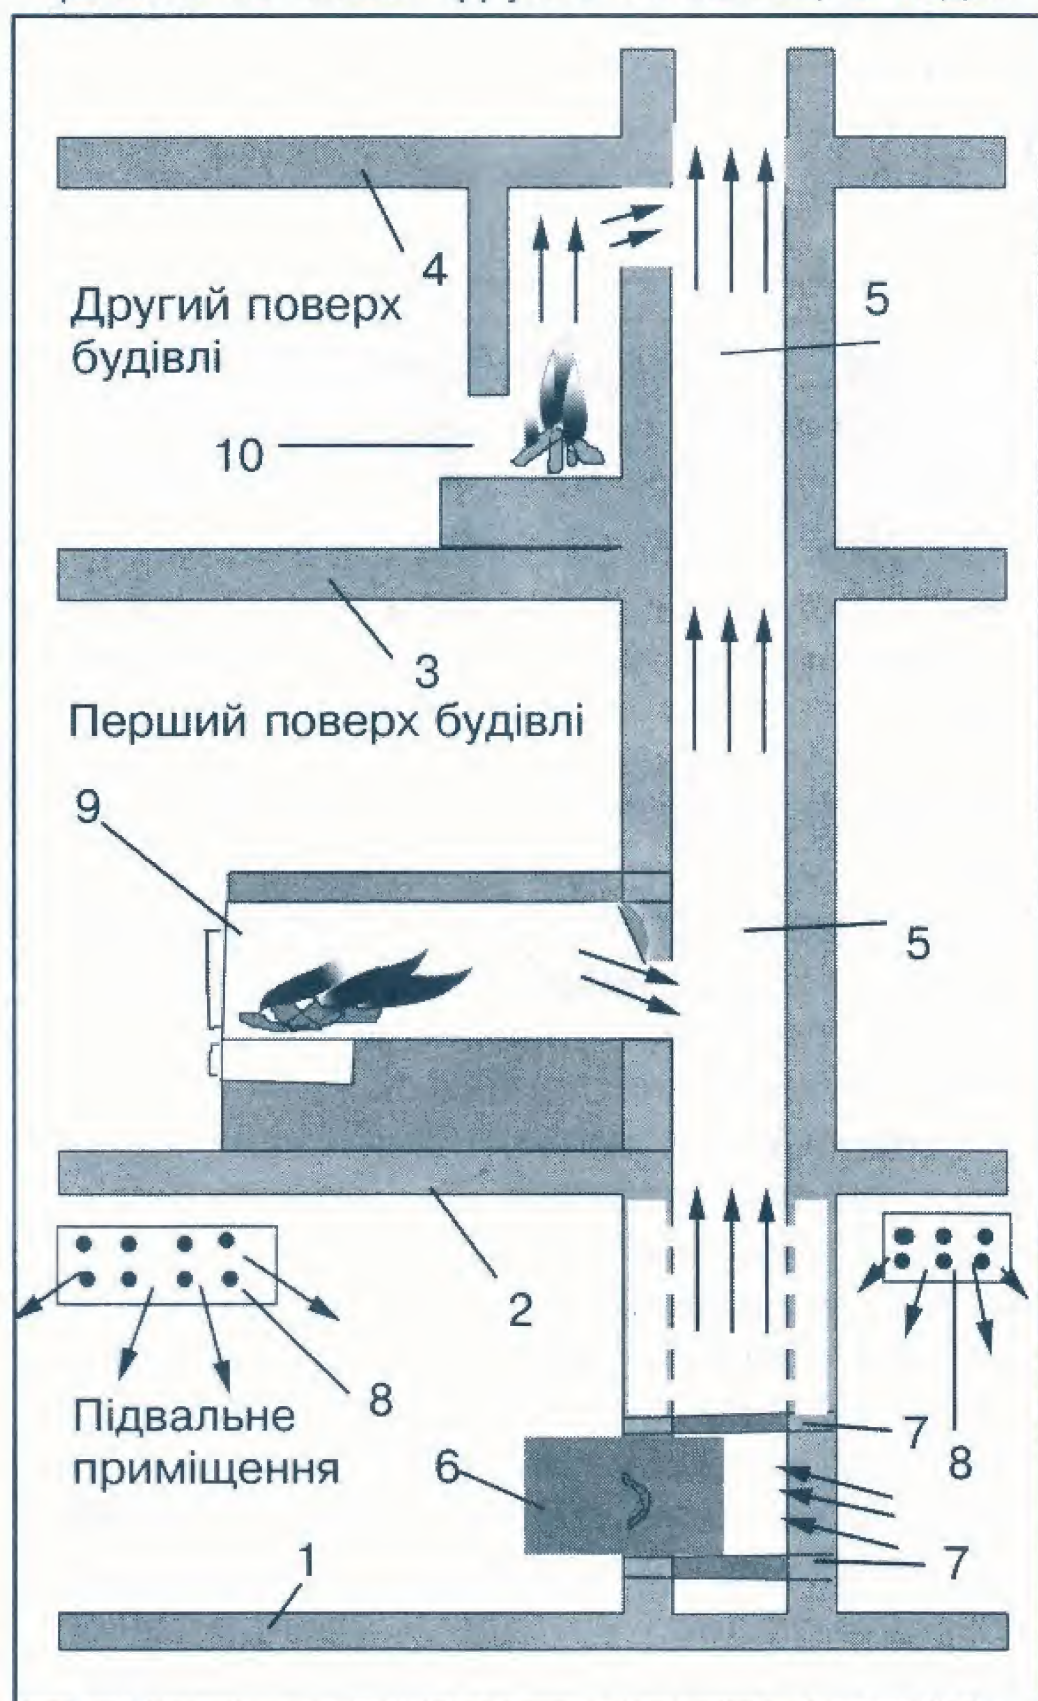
Схема пічного опалення, що забезпечує вентиляцію підвального приміщення: 1 — підлога; 2 — плита перекриття; 3 — плита перекриття 1-го поверху; 4 — плита перекриття 2-го поверху; 5 — димохід; 6 — заслінка вентиляційного отвору; 7 — напрямні полозки заслінки; 8 — вентиляційні вікна; 9 — топка печі; 10 — топка каміна
